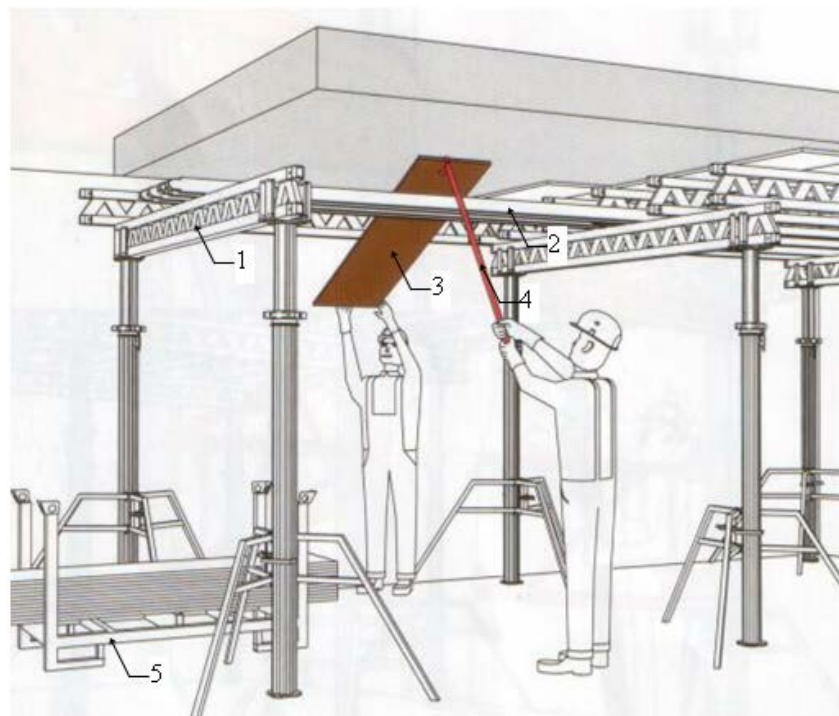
Демонтаж фанеры 1 – продольная балка; 2 – поперечная балка скантованая «набок», 3 – демонтируемый лист фанеры; 4 – монтажная штанга; 5 – контейнер для складирования фанеры
